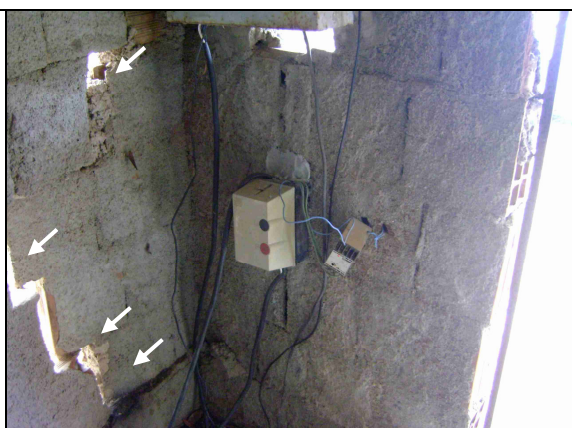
PT-02: Fiação exposta da chave para acionar a bomba e rachaduras profundas na parede.
